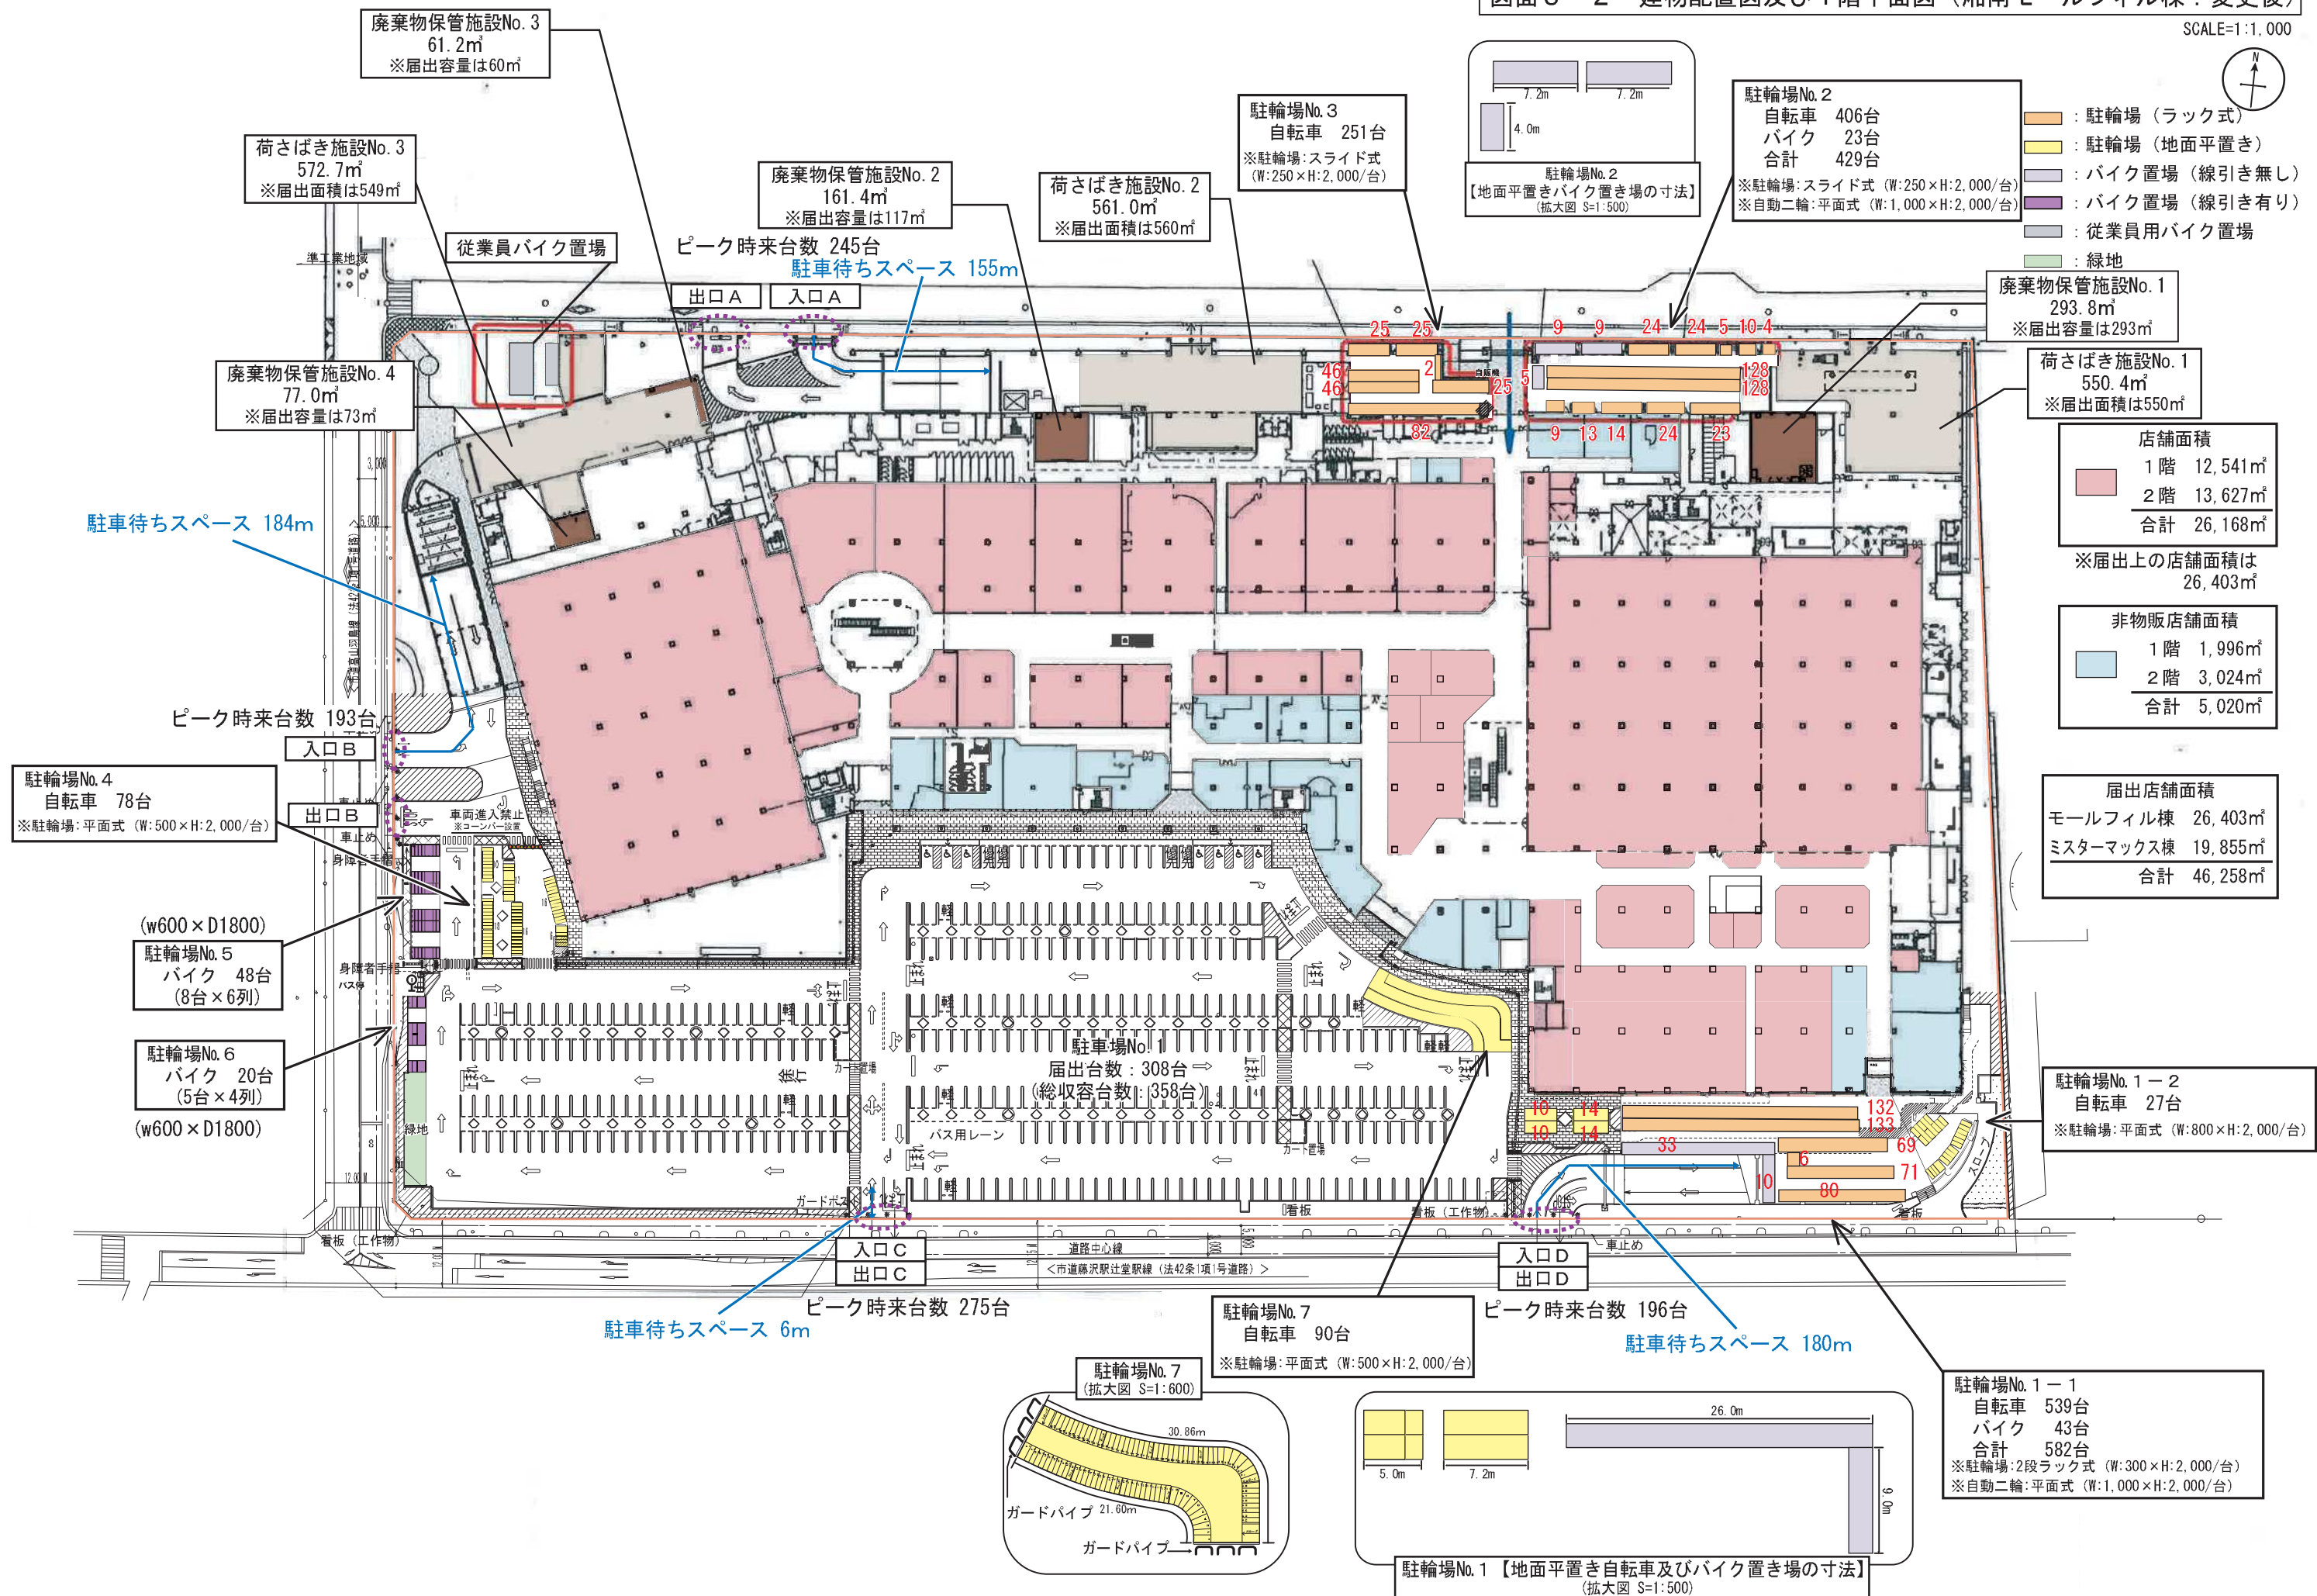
建物配置図及び1階平面図 (湘南モルフィル棟: 変更前)
